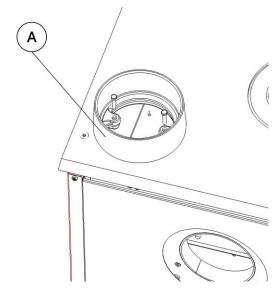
Colocamos a flange superior de saída de fumos.A
